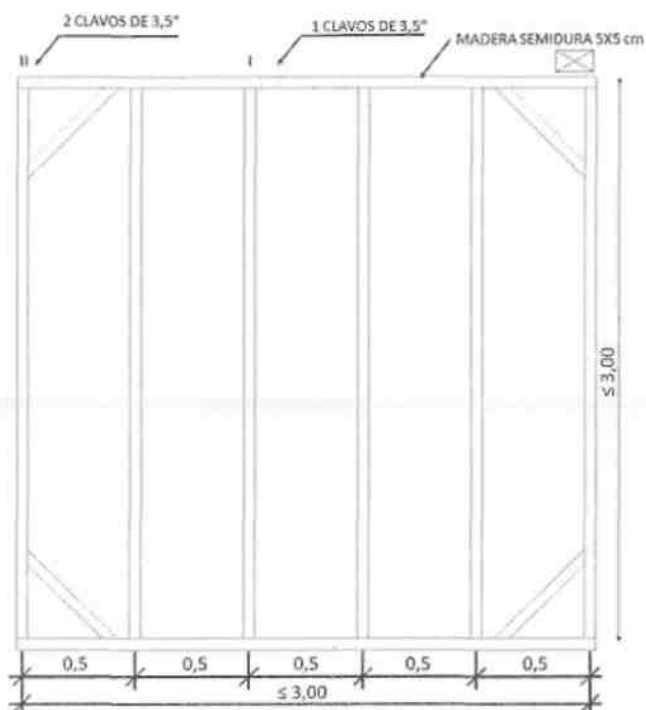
Paneles con estructuras de madera (semidura) de sección 5x5
